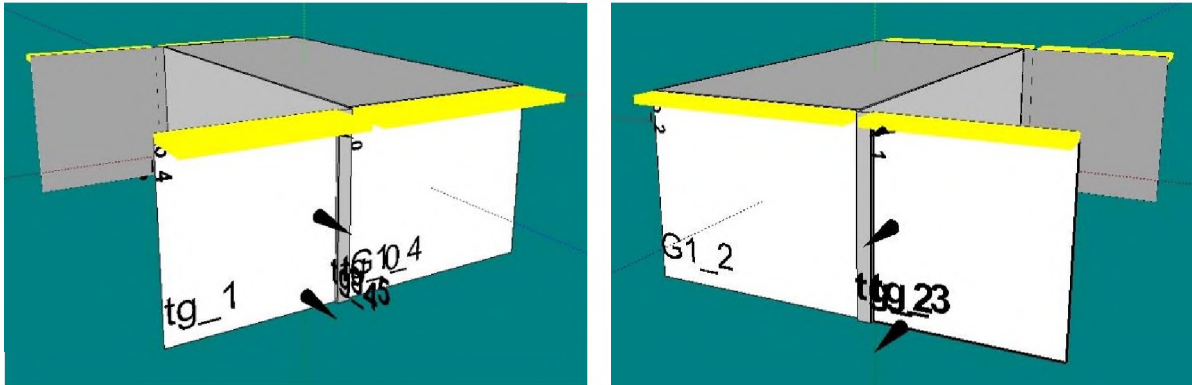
benodigde brandwerende voorzieningen tussen de fietsenstalling en het trappenhuis
